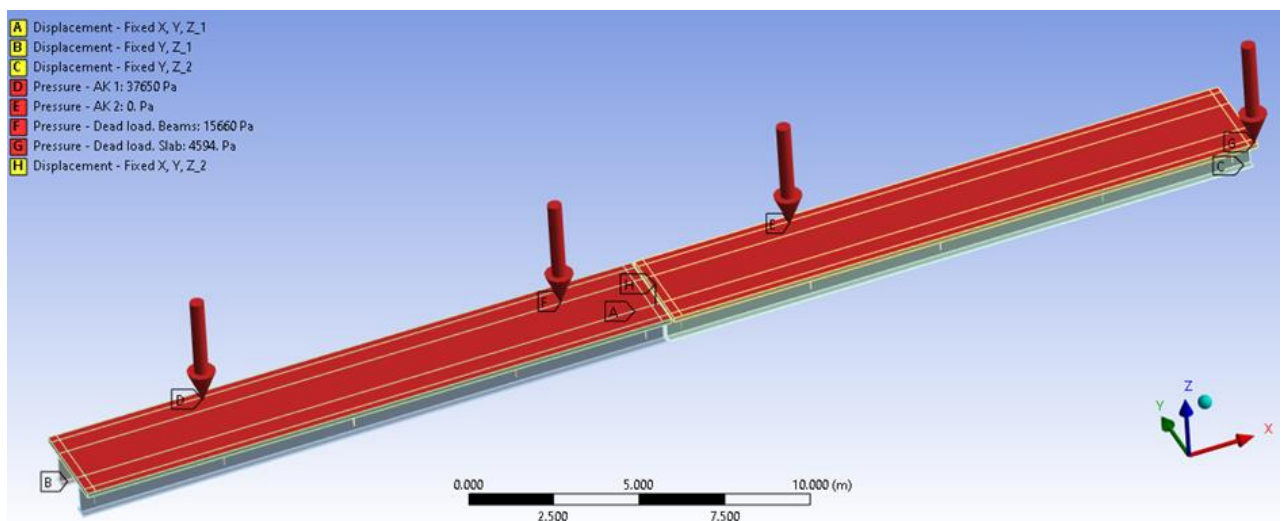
Розрахункова схема двохпрольотної прогонової будови з залізобетонною плитою
